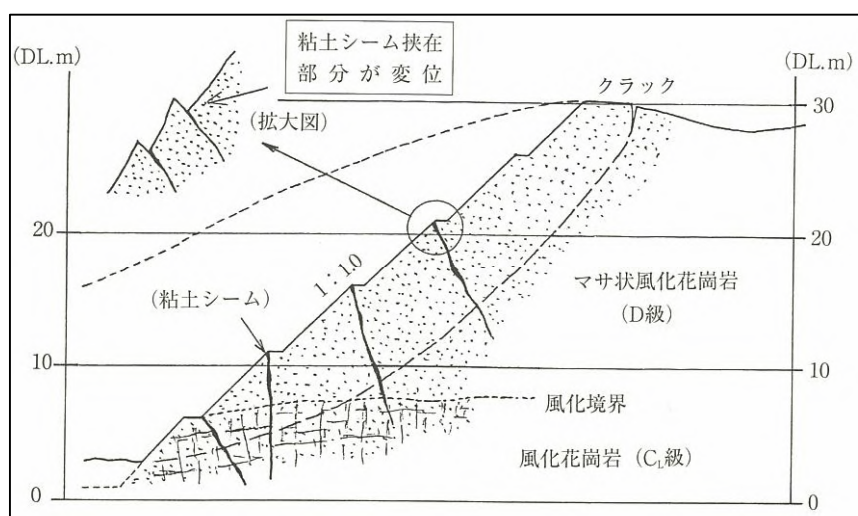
花崗岩地域のトッピング断面図（事例）⁶⁾
